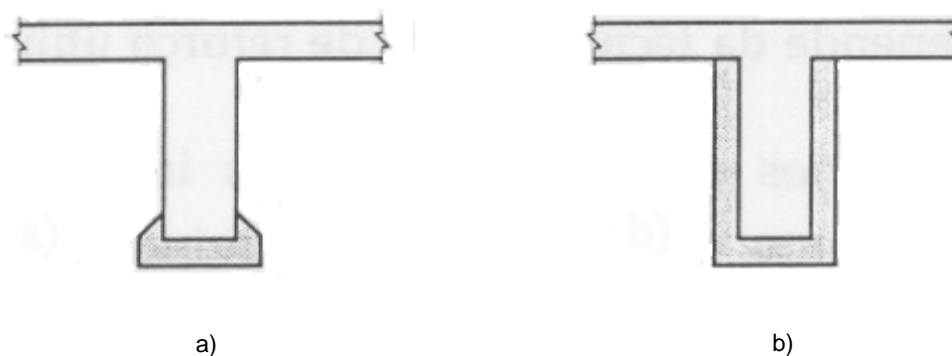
a) Viga reforçada à flexão por encamisamento; b) Viga reforçada à flexão e ao corte por encamisamento, extraído de [16].
